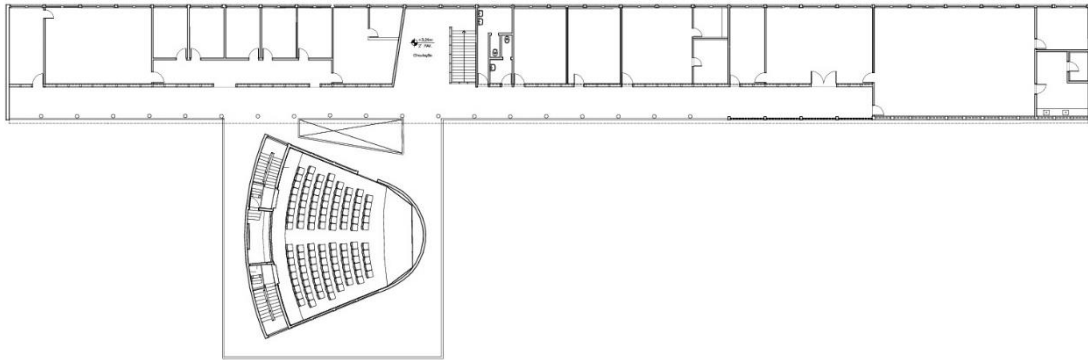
Pavilhão Arthur Neiva: redesenho da planta do 2o pavimento, 1951. Fonte : DAD/COC/Fiocruz
